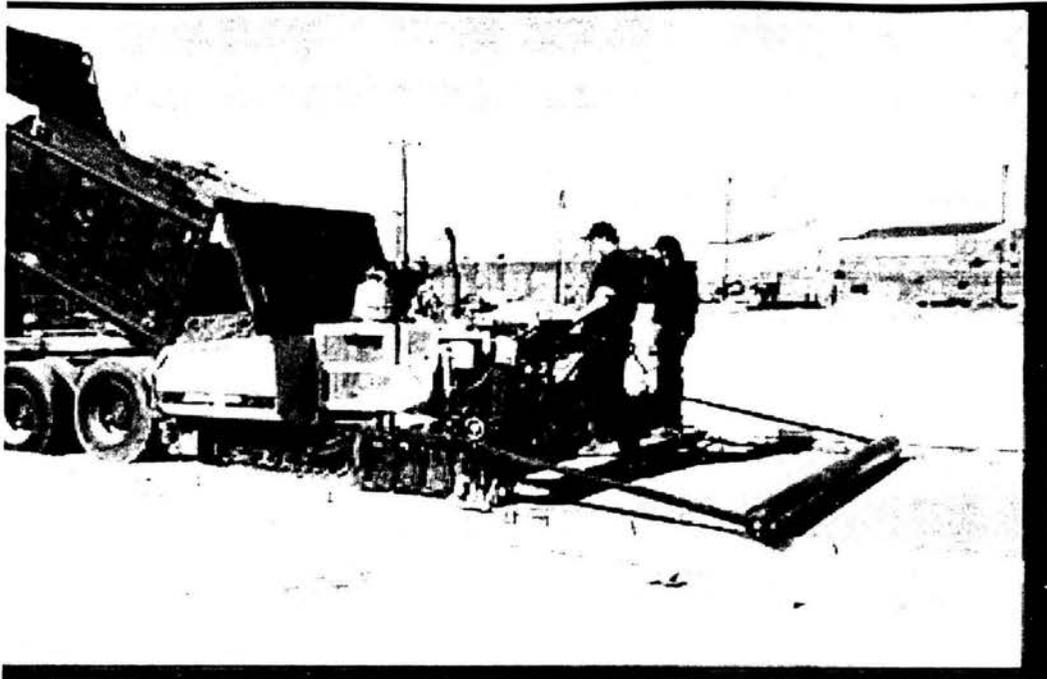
2. Descarga de concreto permeable por medio de un camión
